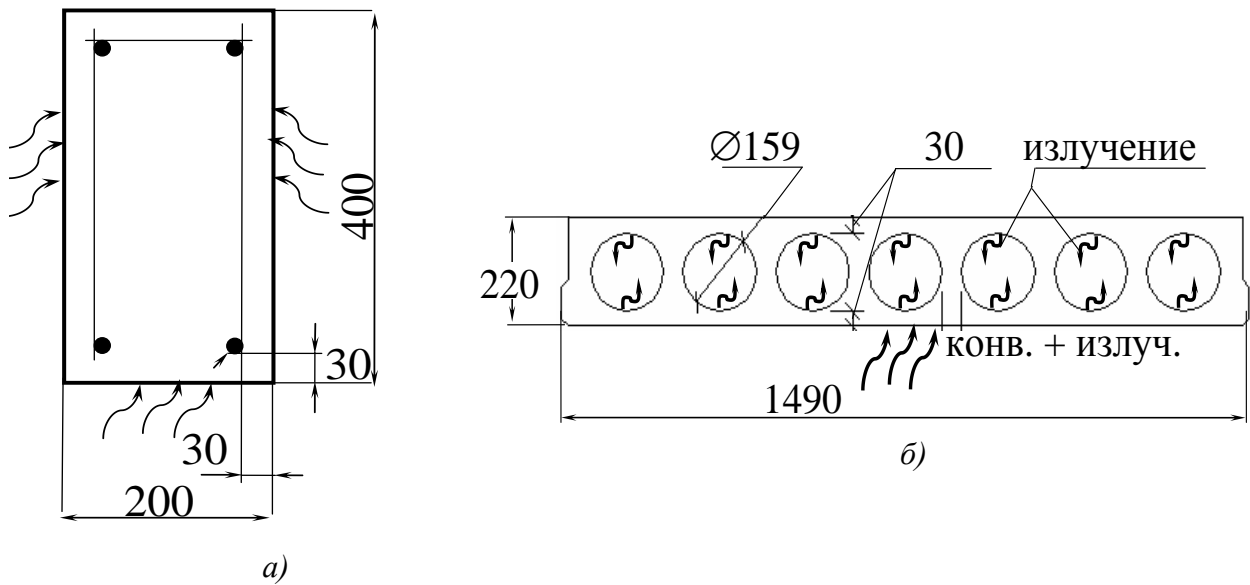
Расчетные схемы сечений железобетонных конструкций:
